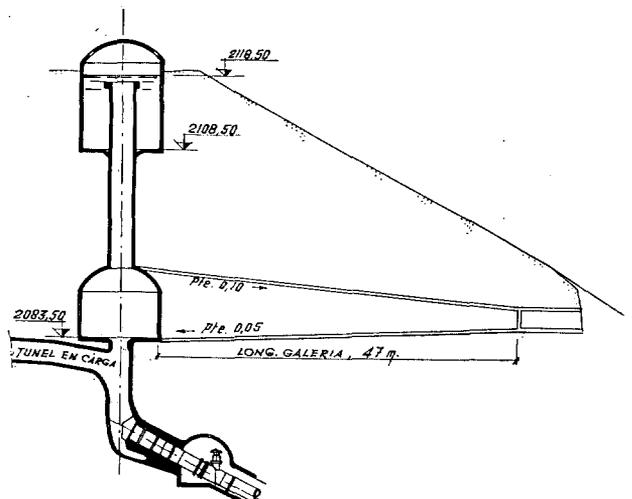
Presa Ibón de Ip. Chimenea de equilibrio.
